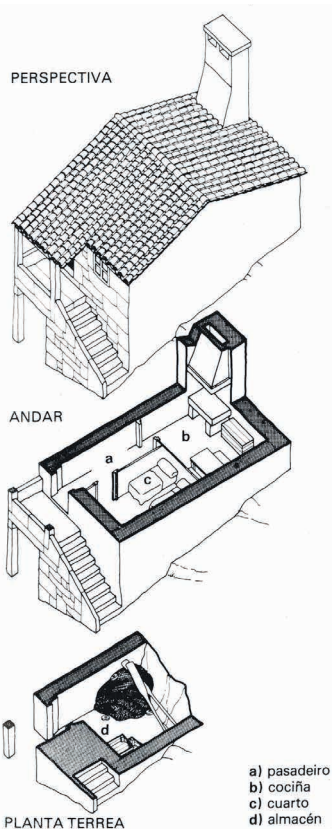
Casa con patín. Autor: Pedro de Llano.
